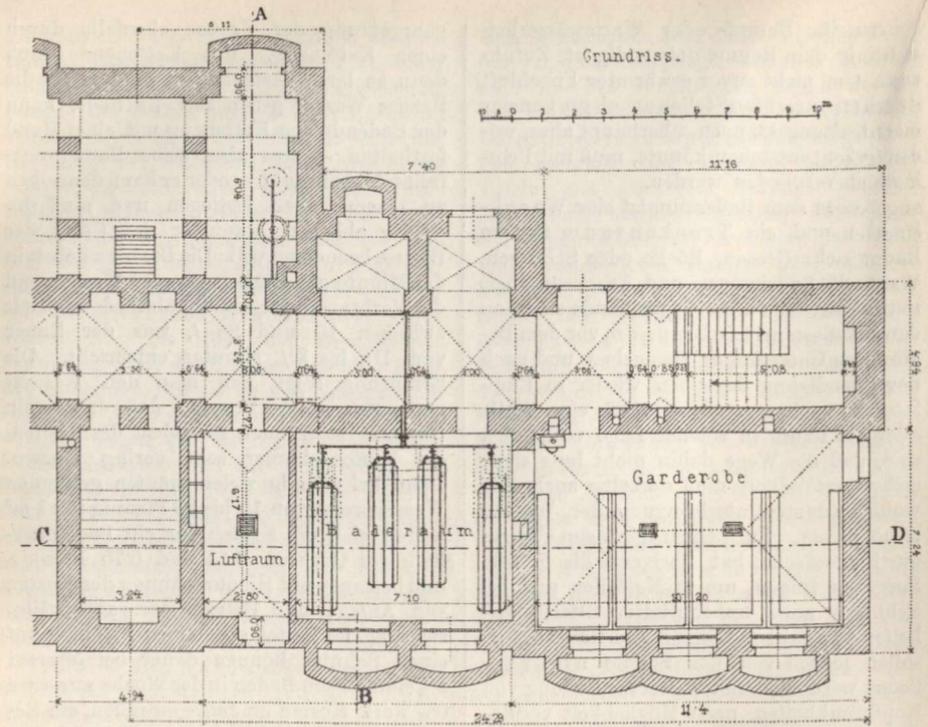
Grundriß des Kellergeschosses und Bodenraumes der Schulbadeanstalt zu Frankfurt a. M.
